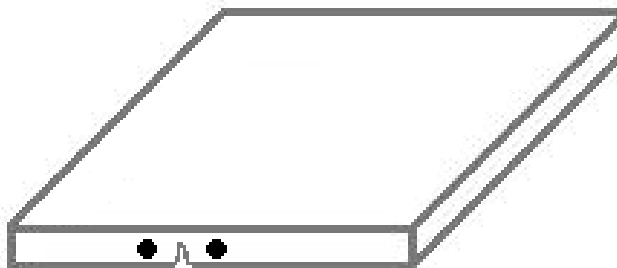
Representação do ensaio de ultra-sons na laje para detectar fissura lateral
